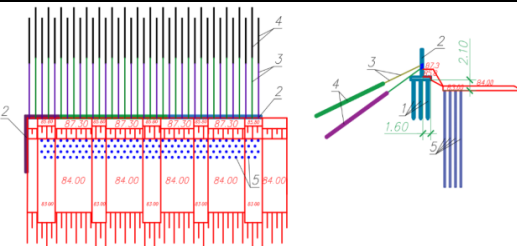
Вертикальная привязка свайных фундаментов в инженерно-геологический разрез: 1 – свайное основание из призматических железобетонных свай под существующий 2 монолитный железобетонный уголкового ростверк; 3, 4 – грунтовые анкера ЭРТ (3 – анкерная тяга; 4 – корень анкера); 5 – буройнъекционные сваи ЭРТ усиления основания; 6 – монолитные железобетонные контрфорсы; 7 – монолитный железобетонный ростверк; 8 – пристенный линейный дренаж
